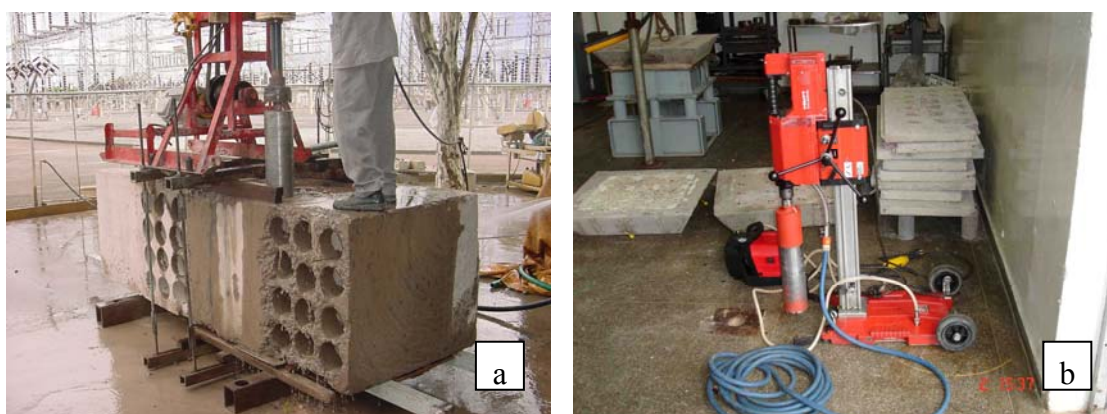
Sondas de extração de testemunhos. (a) sonda Mach 920 em operação; (b) detalhe da sonda Hilti DD 250.
